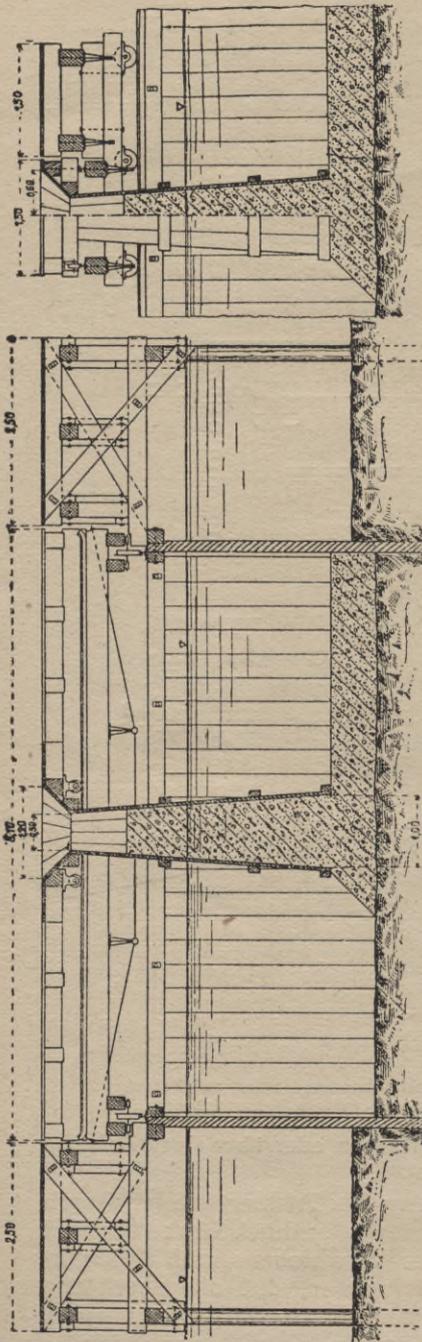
Gründung eines freistehenden Hauses auf Betonpahlrost. — Naßbetonierung mittels Betontrichter.
